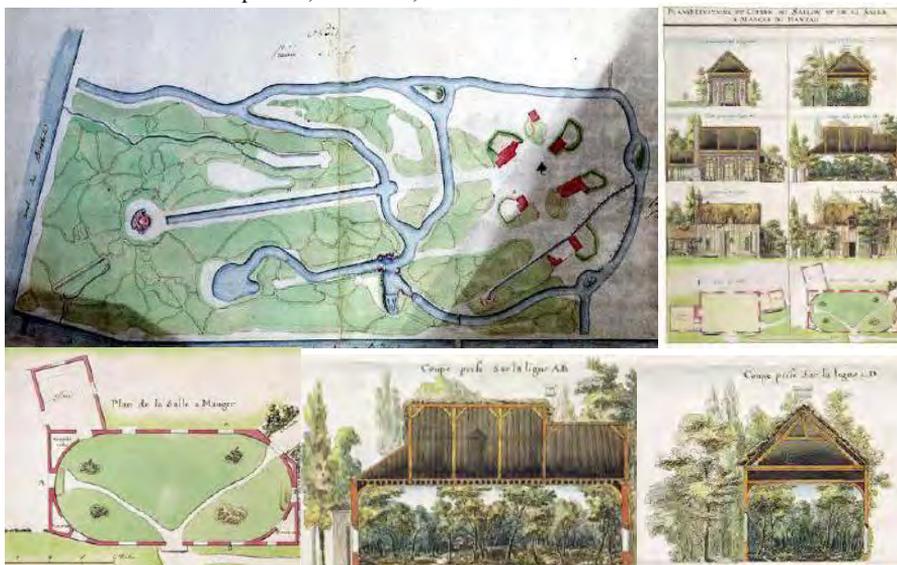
Planimetria d'insieme e dettagli della sala da pranzo dell'Hameau del castello del Principe di Condé a Chantilly. Opera dell'architetto Jean-François Leroy – 1774
